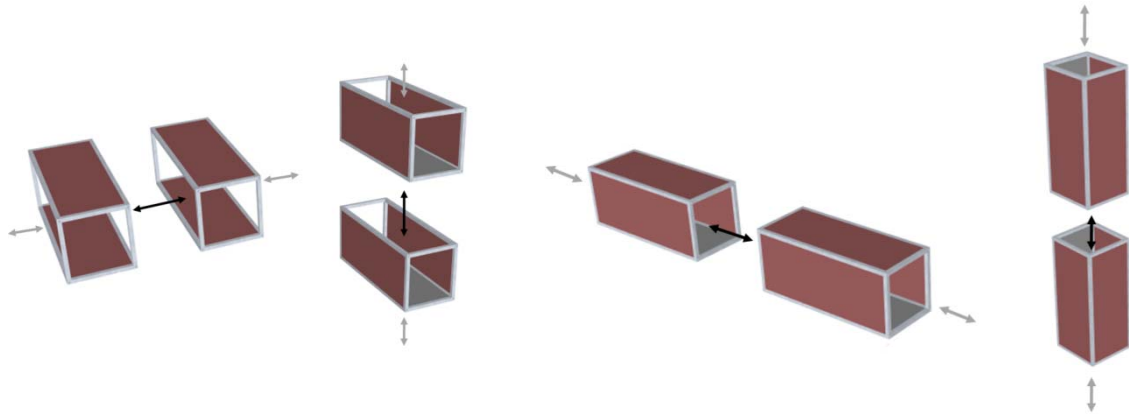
e 8 Ligações espaciais entre contentores: ligação horizontal/ vertical (longitudinal) e ligação horizontal/ vertical (extremidades) <sup>[160]</sup>
